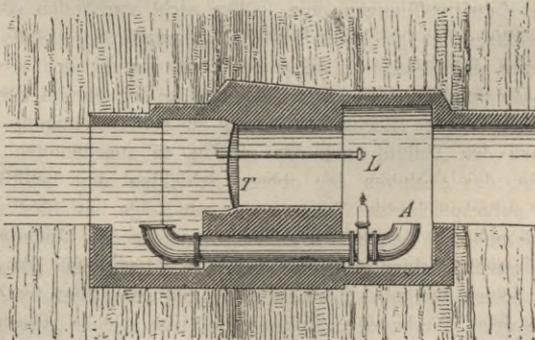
Neuer Sammelstollen für das Aachener Wasserwerk.
